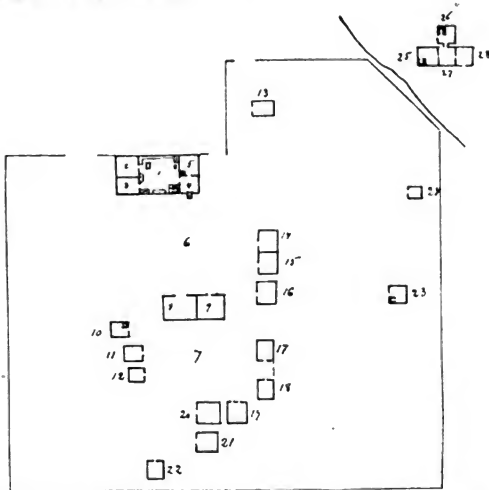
Grundriss eines österbottnischen Bauerhofes. Seinäjoki. Wasa.
